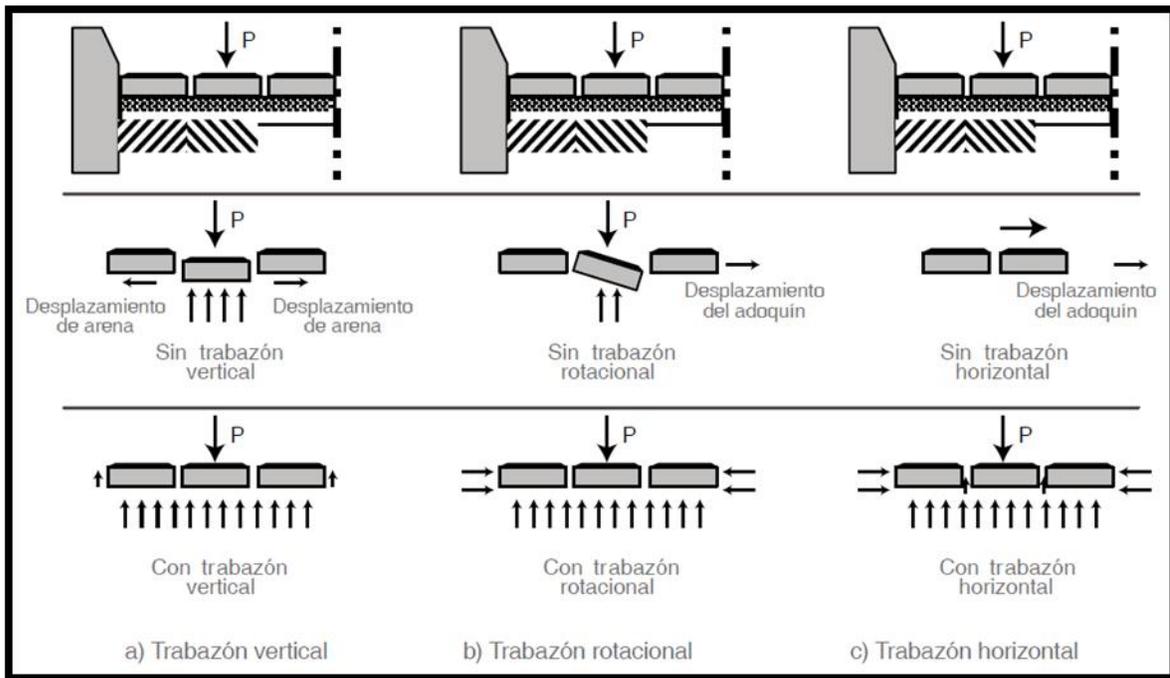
Trabazón vertical, horizontal y rotacional de un pavimento de adoquín
